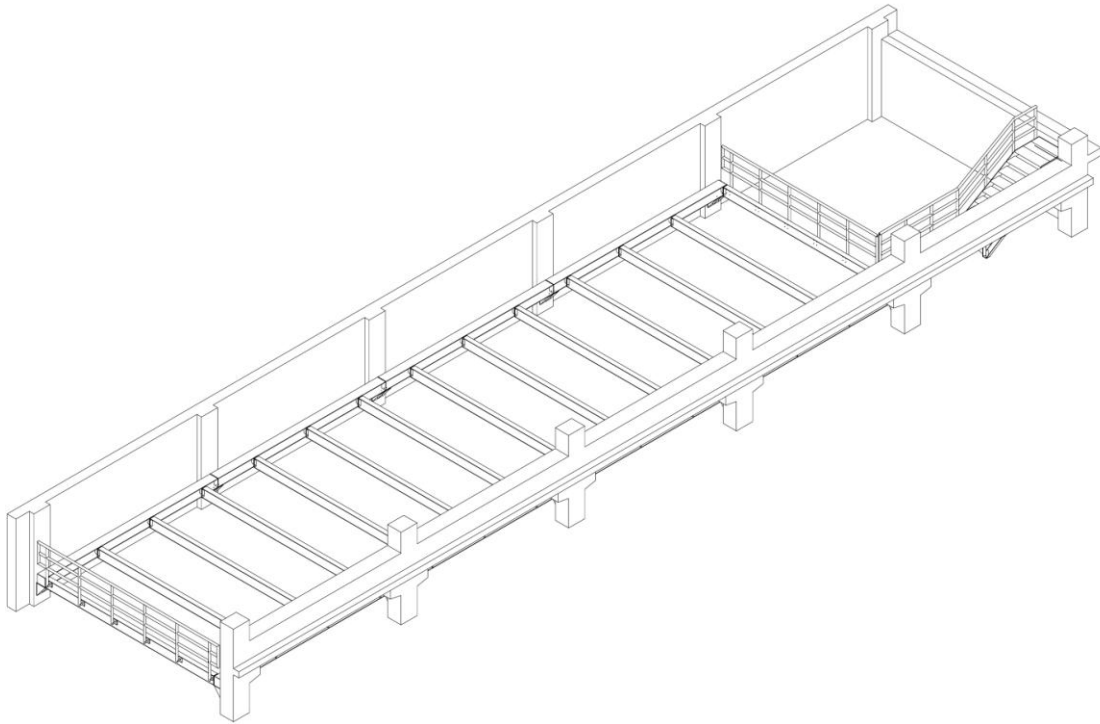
Particolare di A.2012.a.sa.T02 - Progetto della struttura - Vista assometrica soppalco
